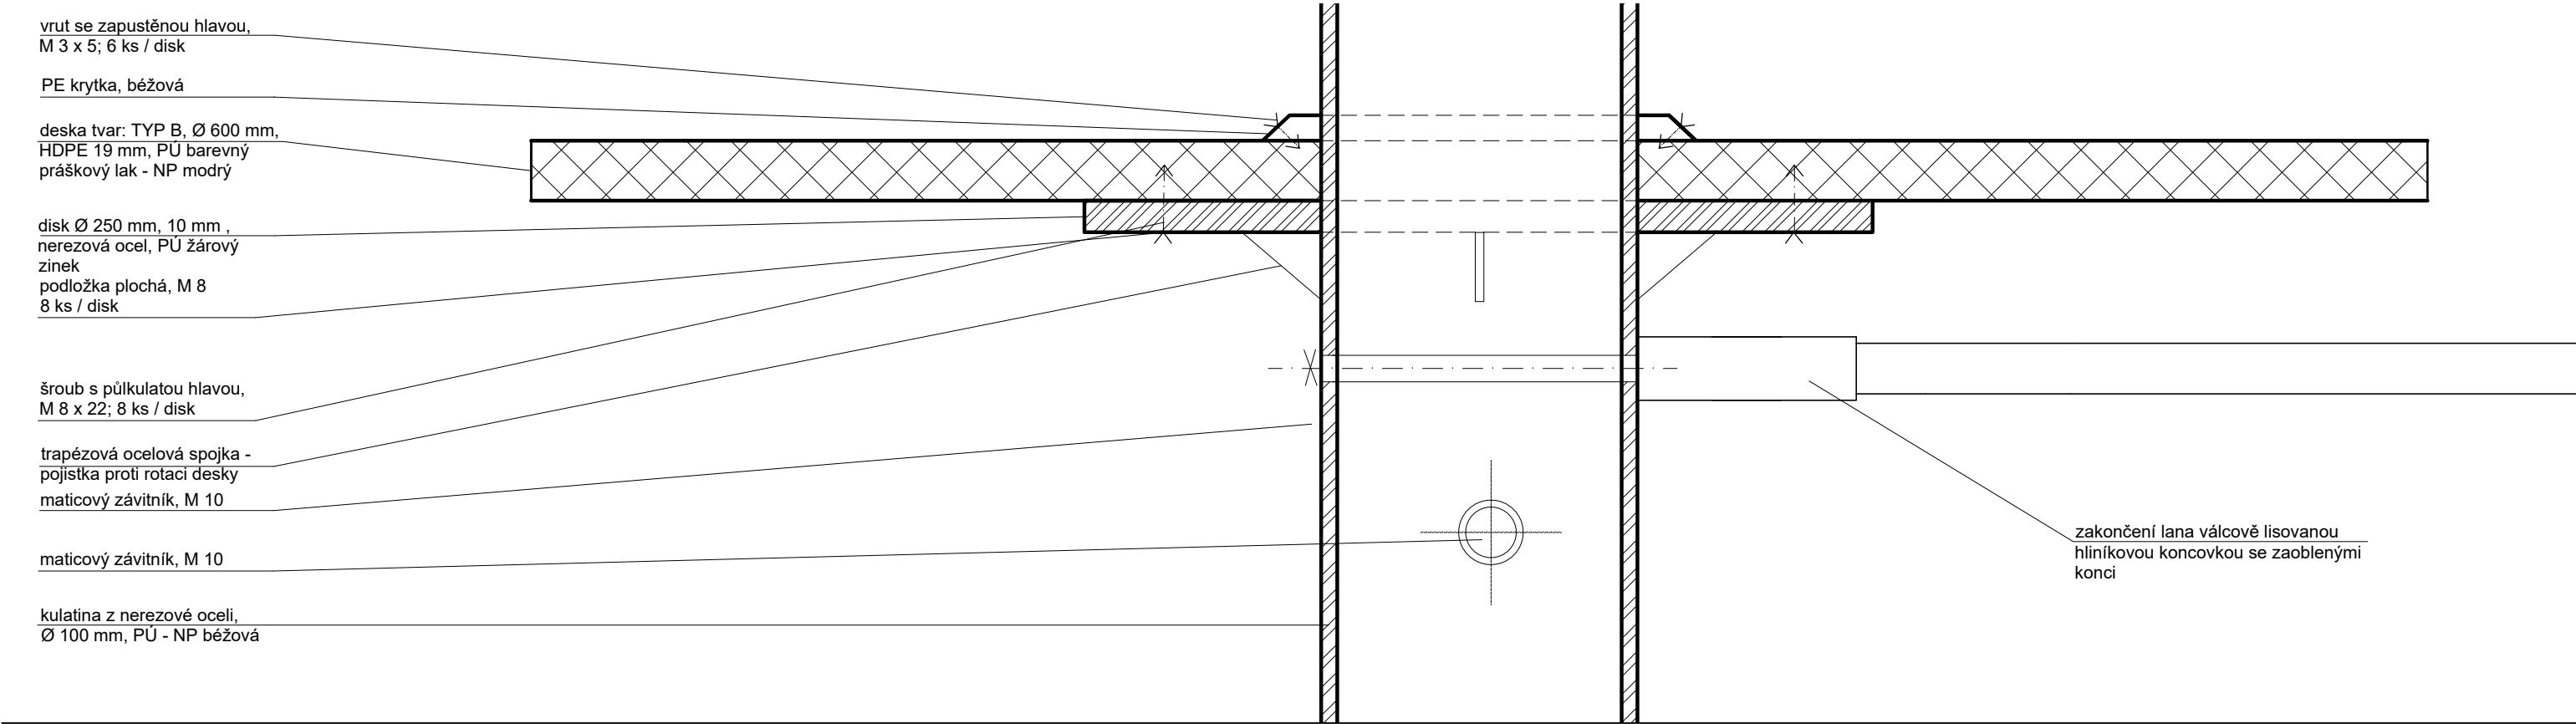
DETAIL V - SPOJKY LANOVÉHO PRVKU PRO ŠPLHACÍ SÍTĚ, M 1:5
